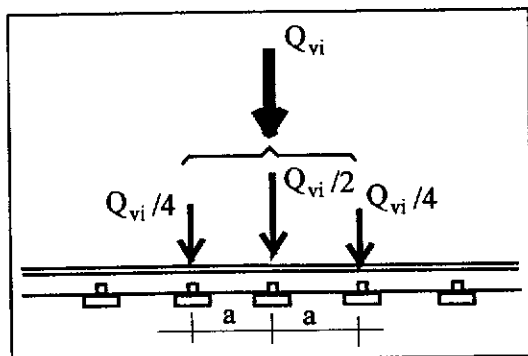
Distribuzione longitudinale dei carichi assiali
